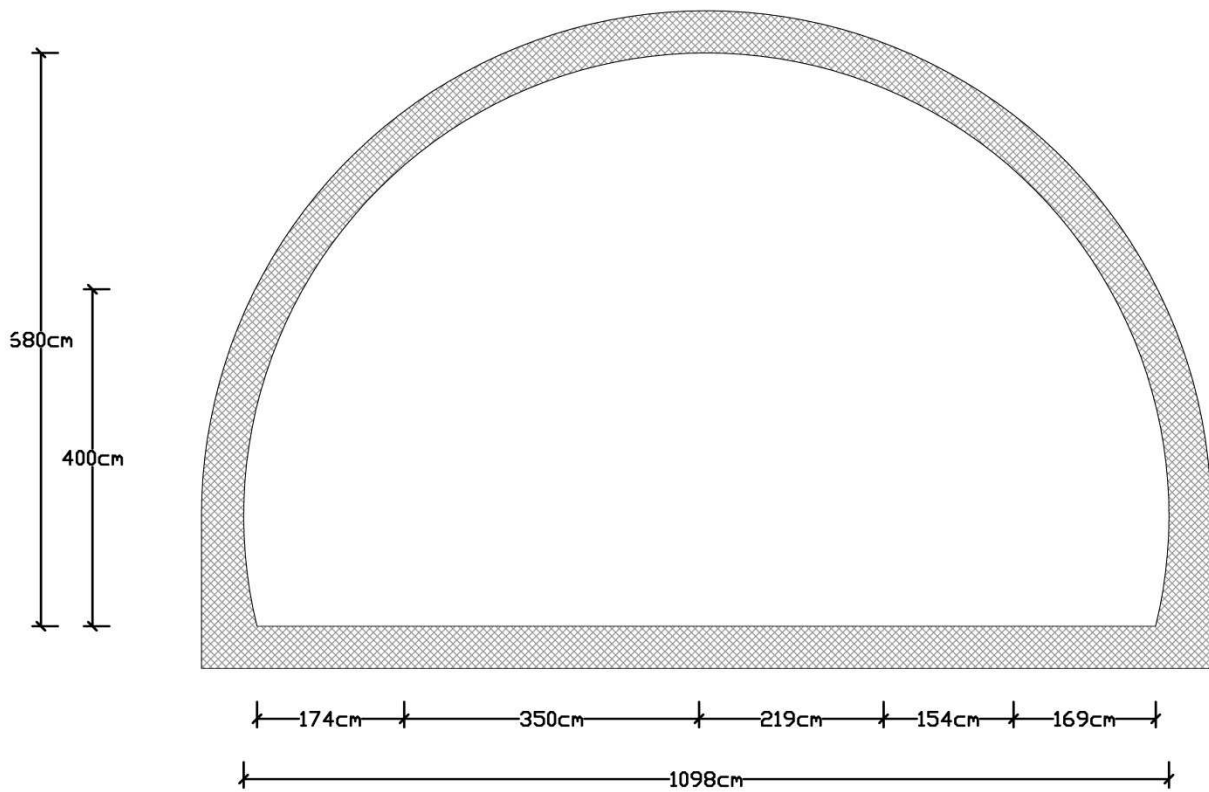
piante e sezioni by-pass pedonali e carrabili
